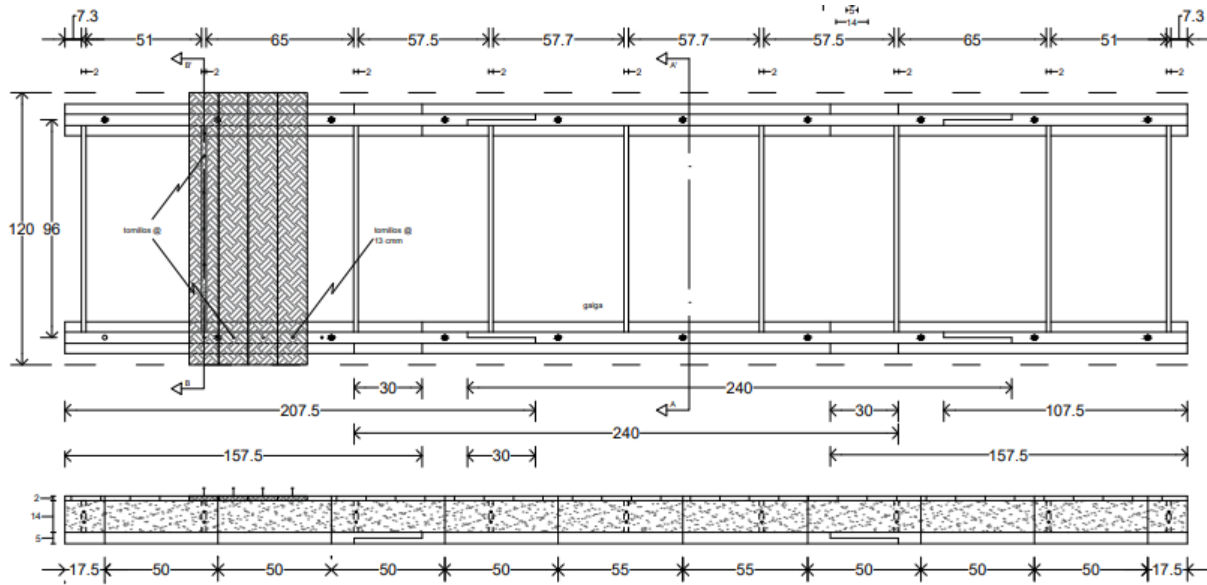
Vista del modelo en planta y en perfil (cotas en cm).
